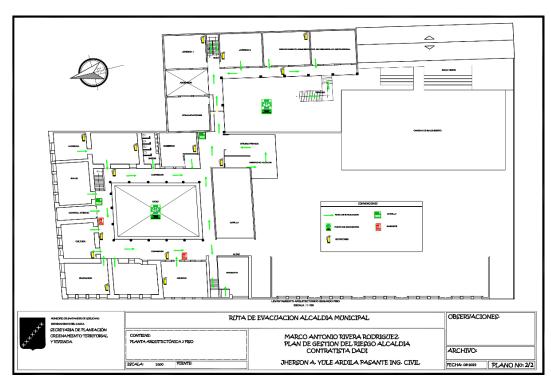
y 7 Rutas de evacuación planta arquitectónica edificación CAM primer y segundo piso archivo rutasdeevacuacion.dwg
